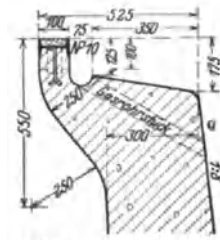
Schnitt durch die Betonseitenwand des Versuchsbeckens. Konstruktion des Strandes.
